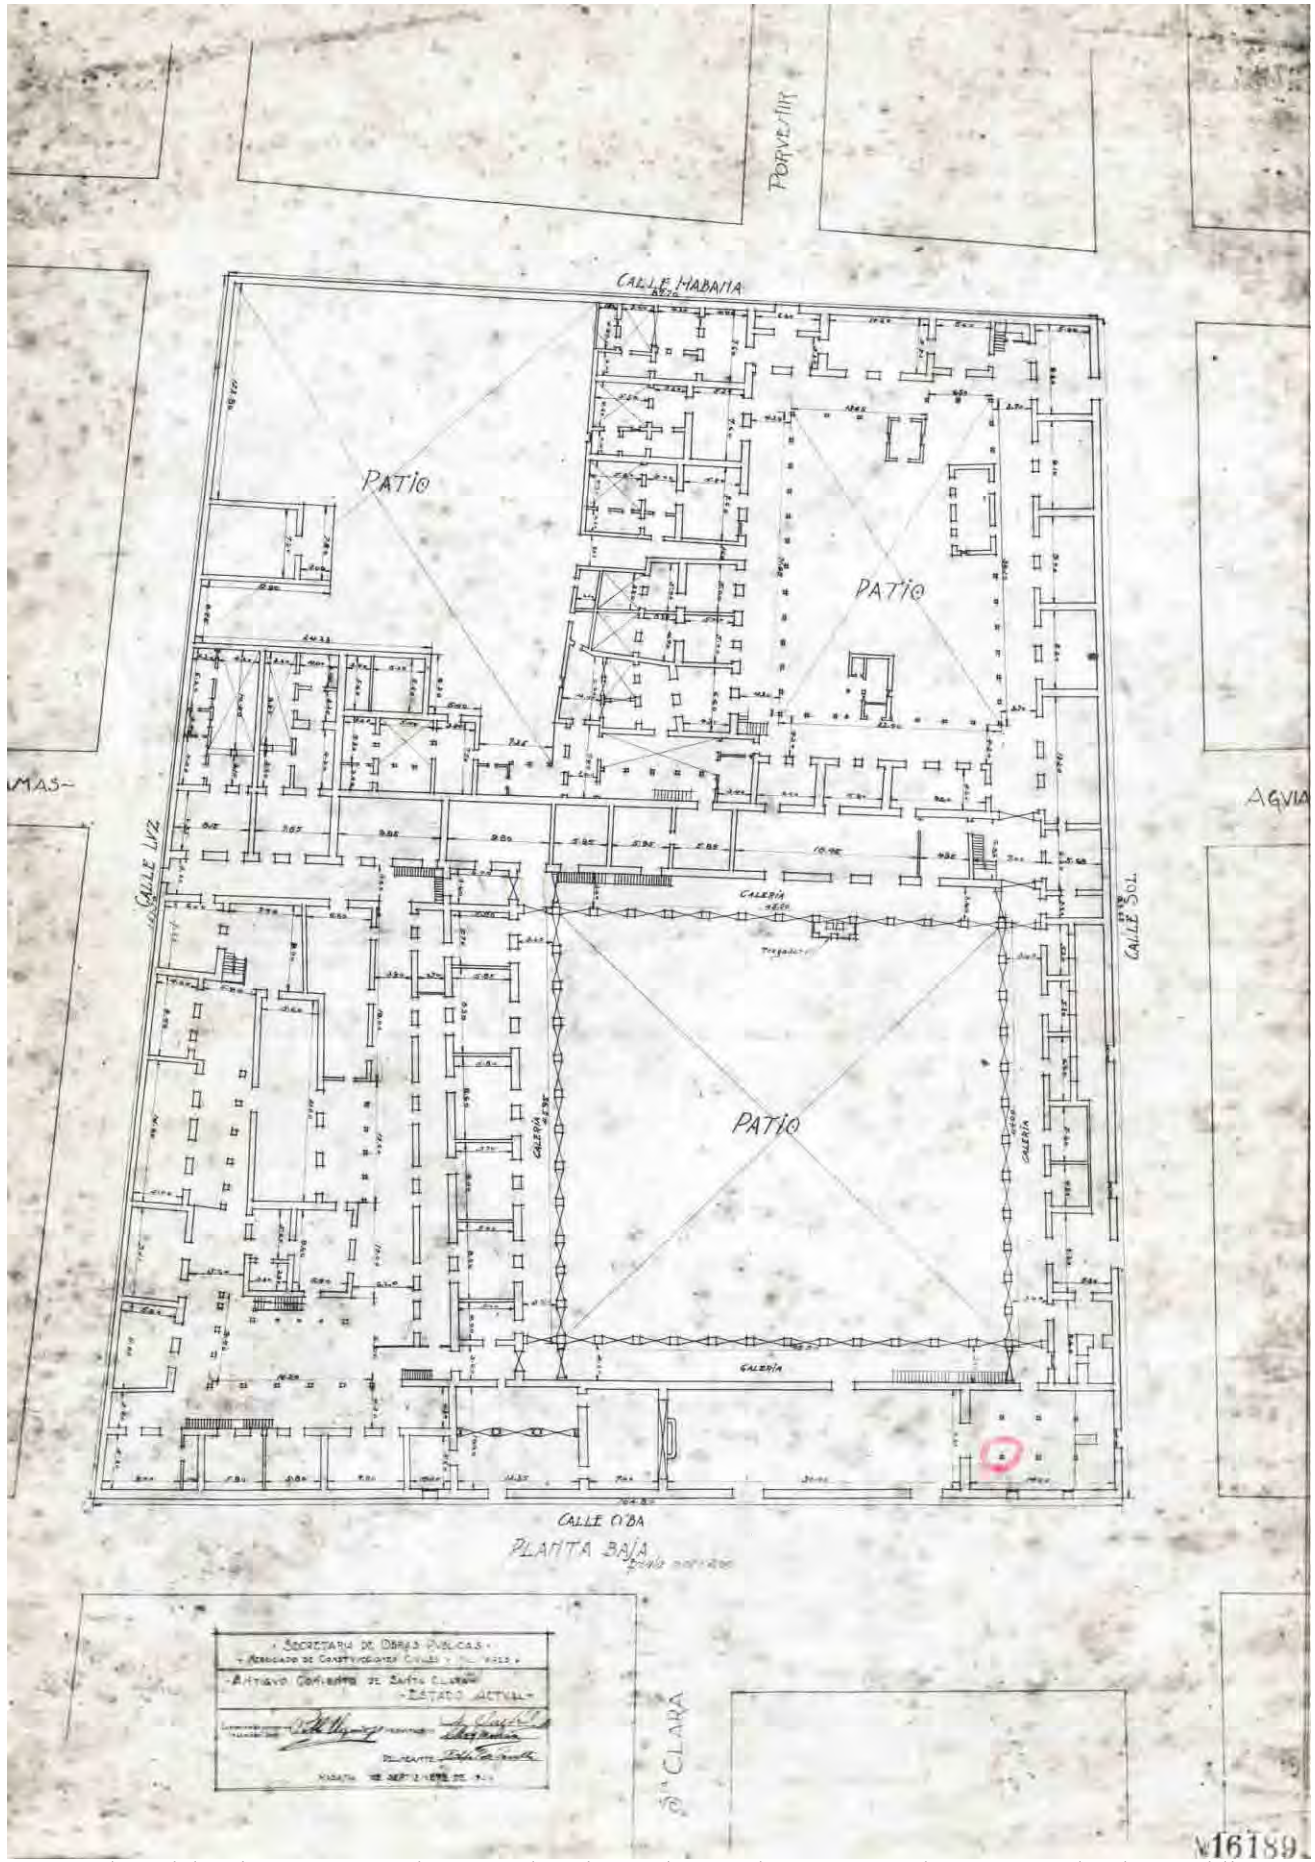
Plano del antiguo convento de Santa Clara de Asís levantado en 1924 por la Secretaría de Obras Públicas
